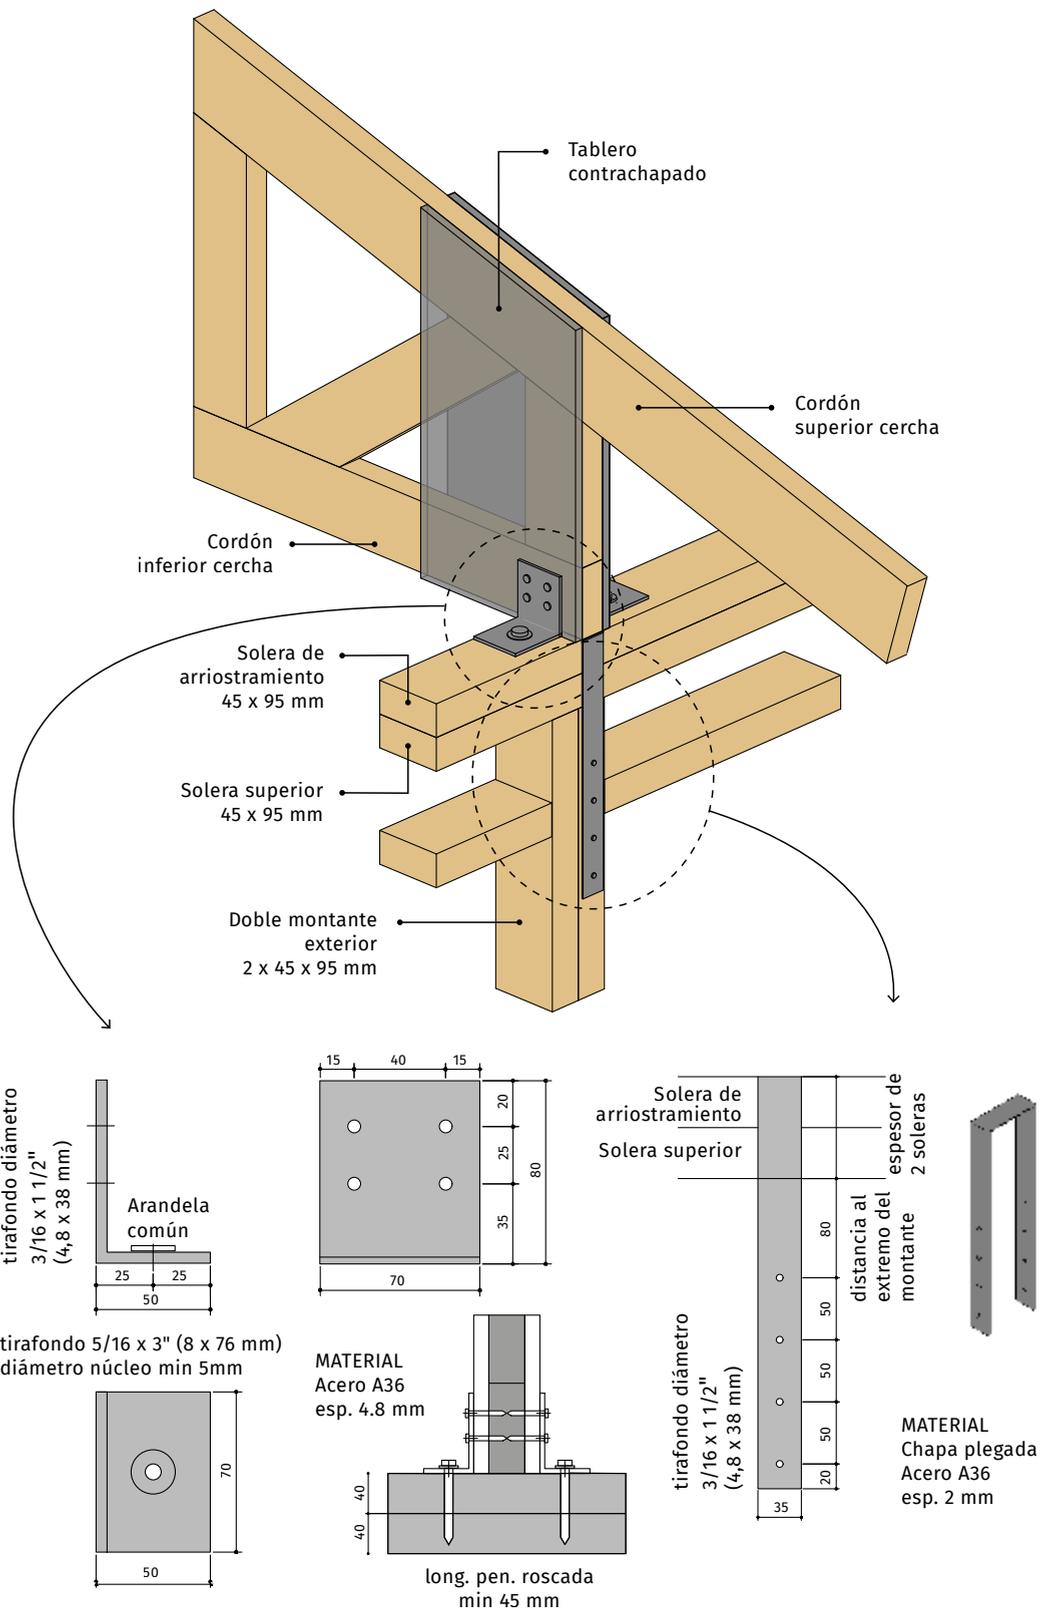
Detalle de la unión cercha-solera y solera-montante sobre los muros de ambas fachadas
